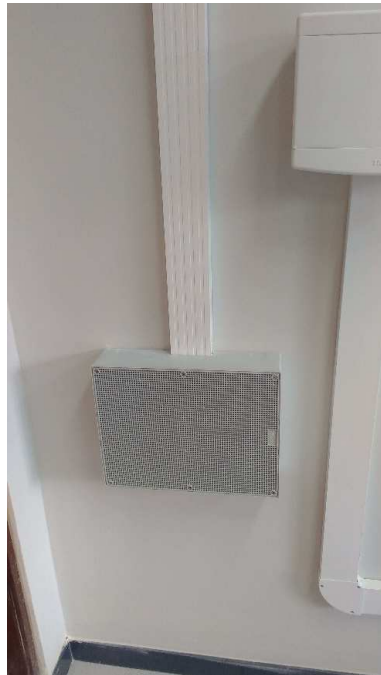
Detalhe do ponto de consolidação implantado na sala do Suporte
